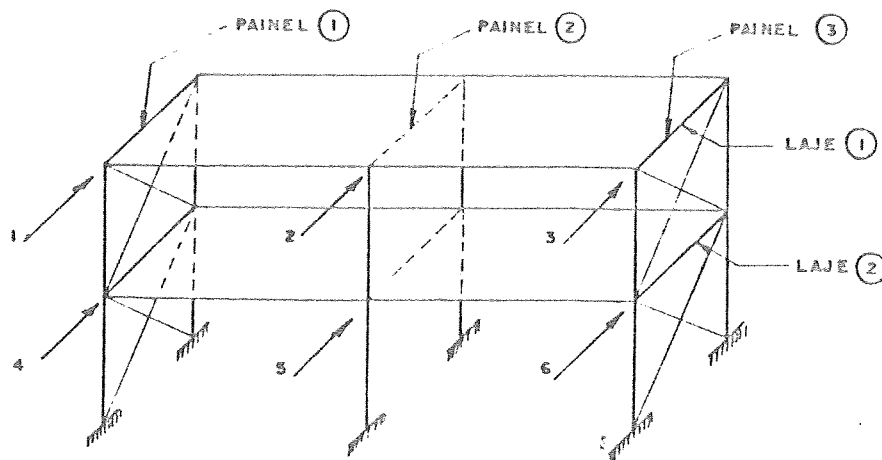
Numeração das lajes, painéis transversais e dos deslocamentos de uma estrutura de edifício com 3 painéis transversais e 2 lajes.
